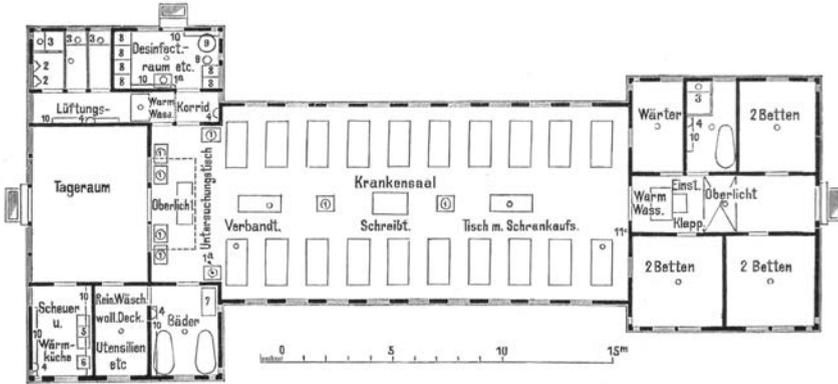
Städtisches Allgemeines Krankenhaus Moabit, erbaut 1872-96, Architekt: Hermann Blankenstein, Grundriss einer Baracke, Druck 1896
